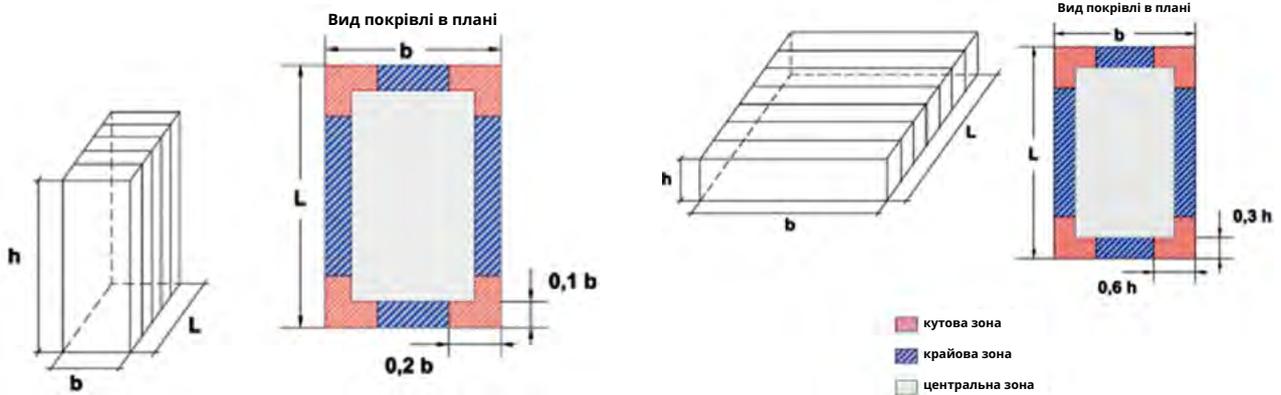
Варіант розкладки і кріплення полотен полімерної мембрани з бетонною основою або цементно-піщаною стяжки
